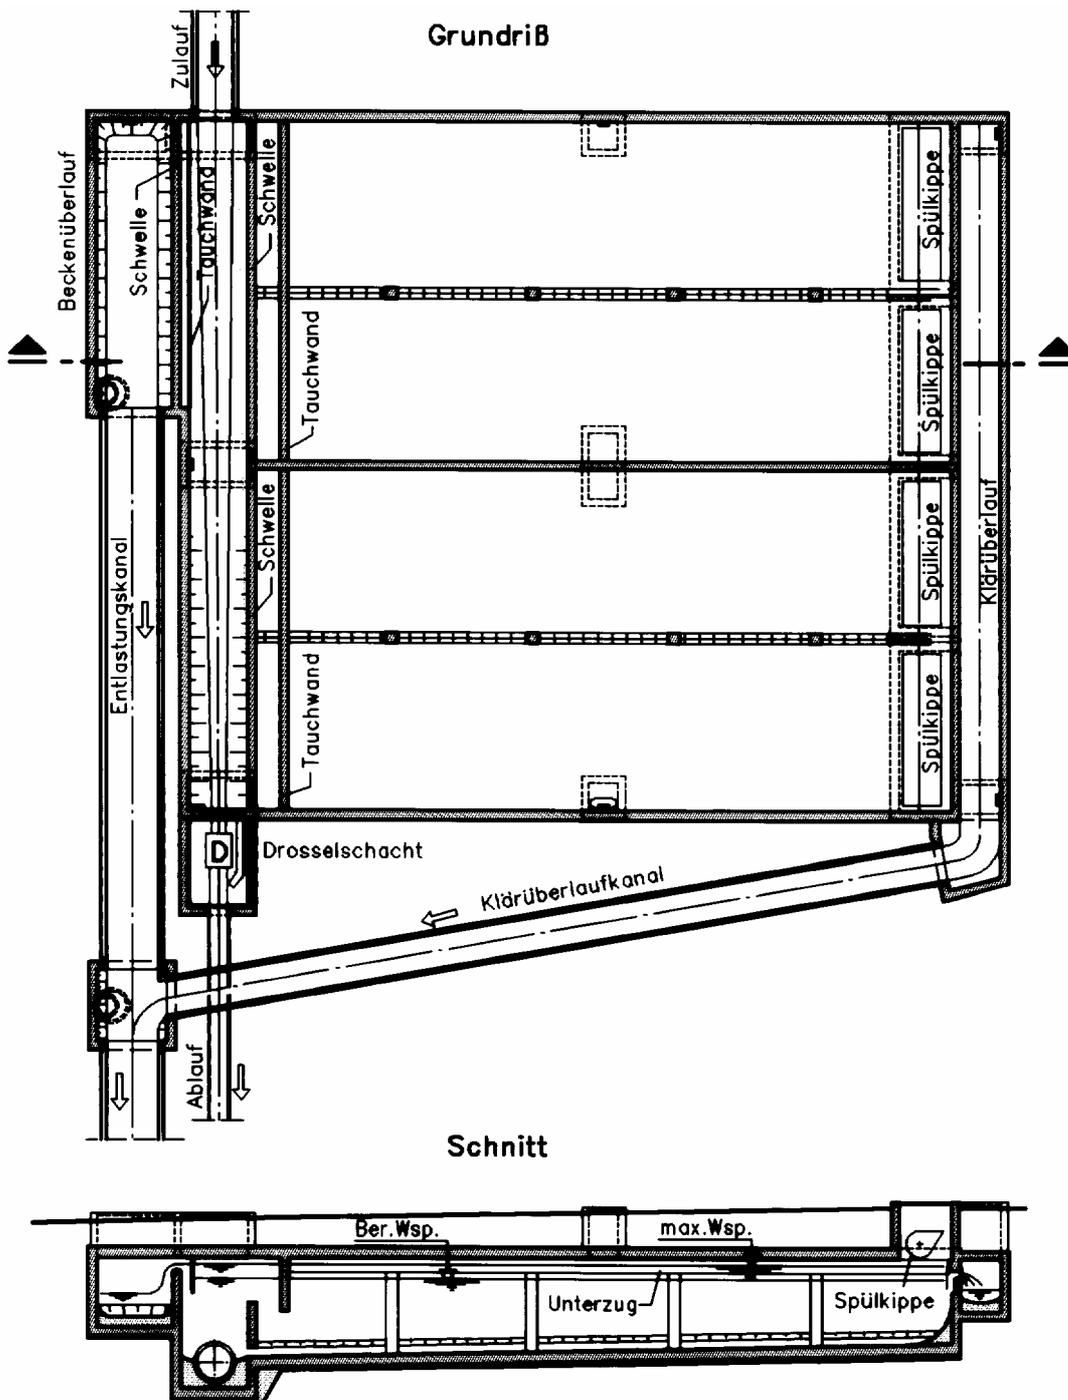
Systemzeichnung eines Rechteckbeckens (Durchlaufbecken) im unechten Nebenschluß mit Spülkippen
